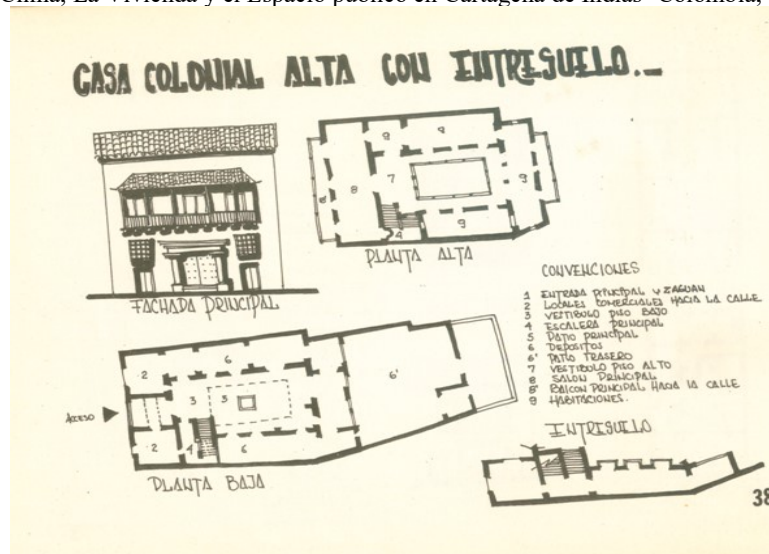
Vista en Planta de la Casa Colonial Alta con Entresuelo
